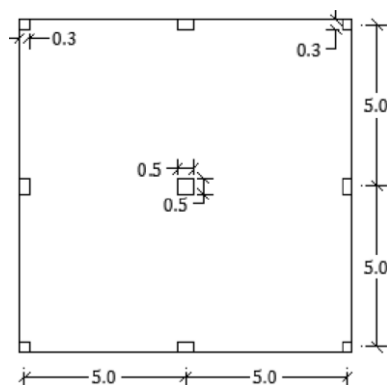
Planta estrutural da laje fungiforme (retirado de Camacho [10]).
